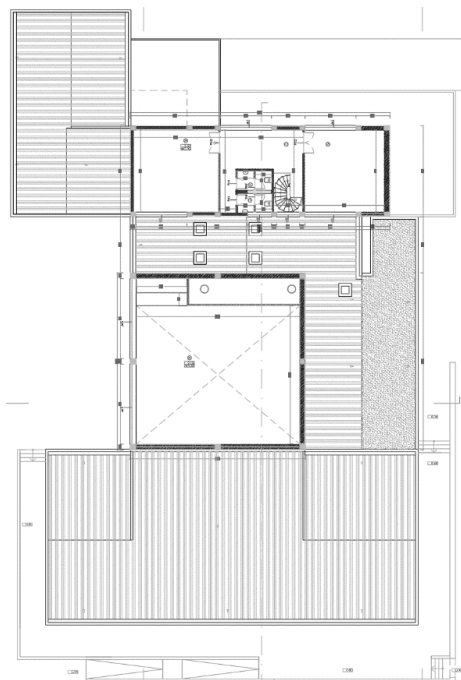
Planta do Piso 2 do Bloco A. [33]
